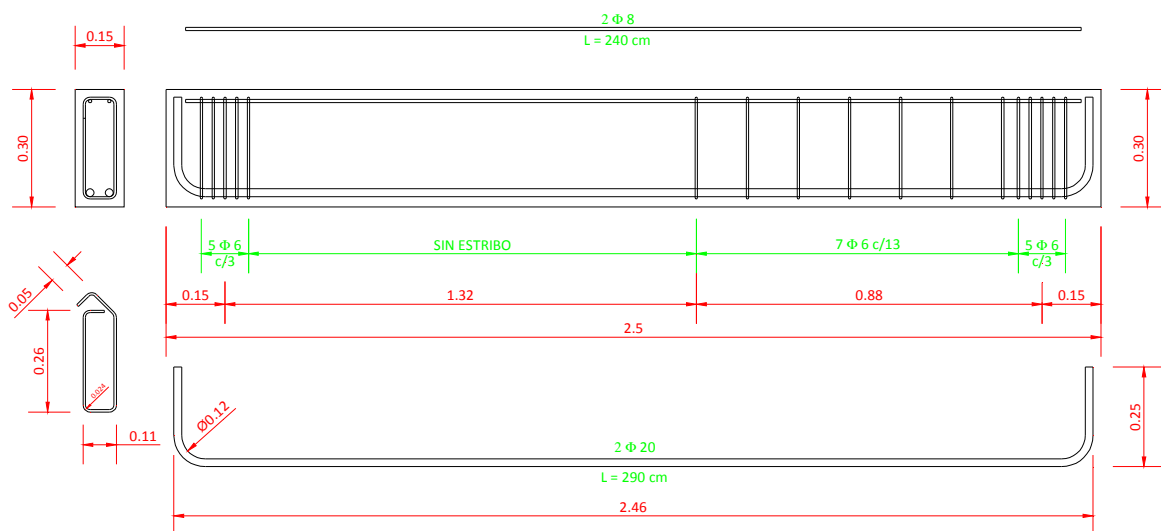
Eschema de armado longitudinal y estribado de vigas. Diagrama de carga del ensayo. Serie C
